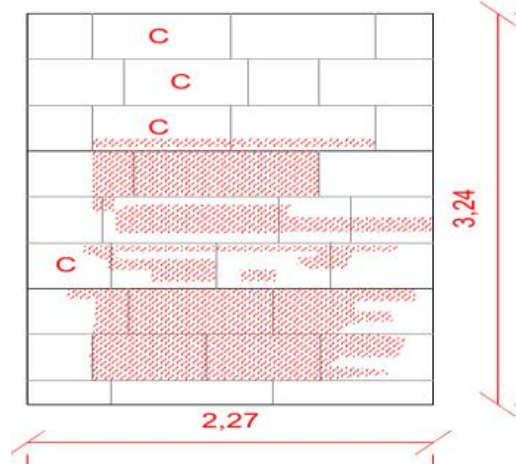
Plano con achurado de piezas nuevas y cambiadas (C)
